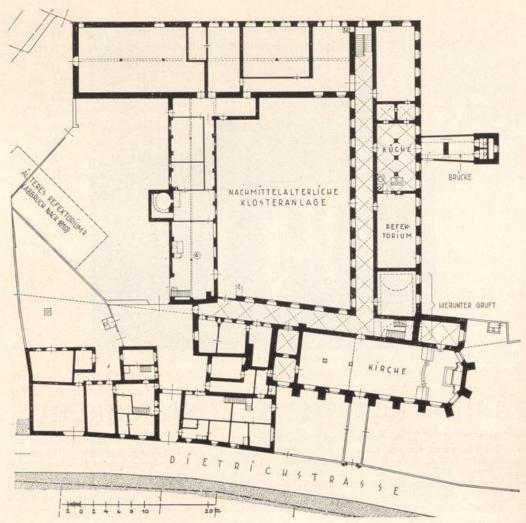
Klarissenkloster und -kirche, Grundriß,
